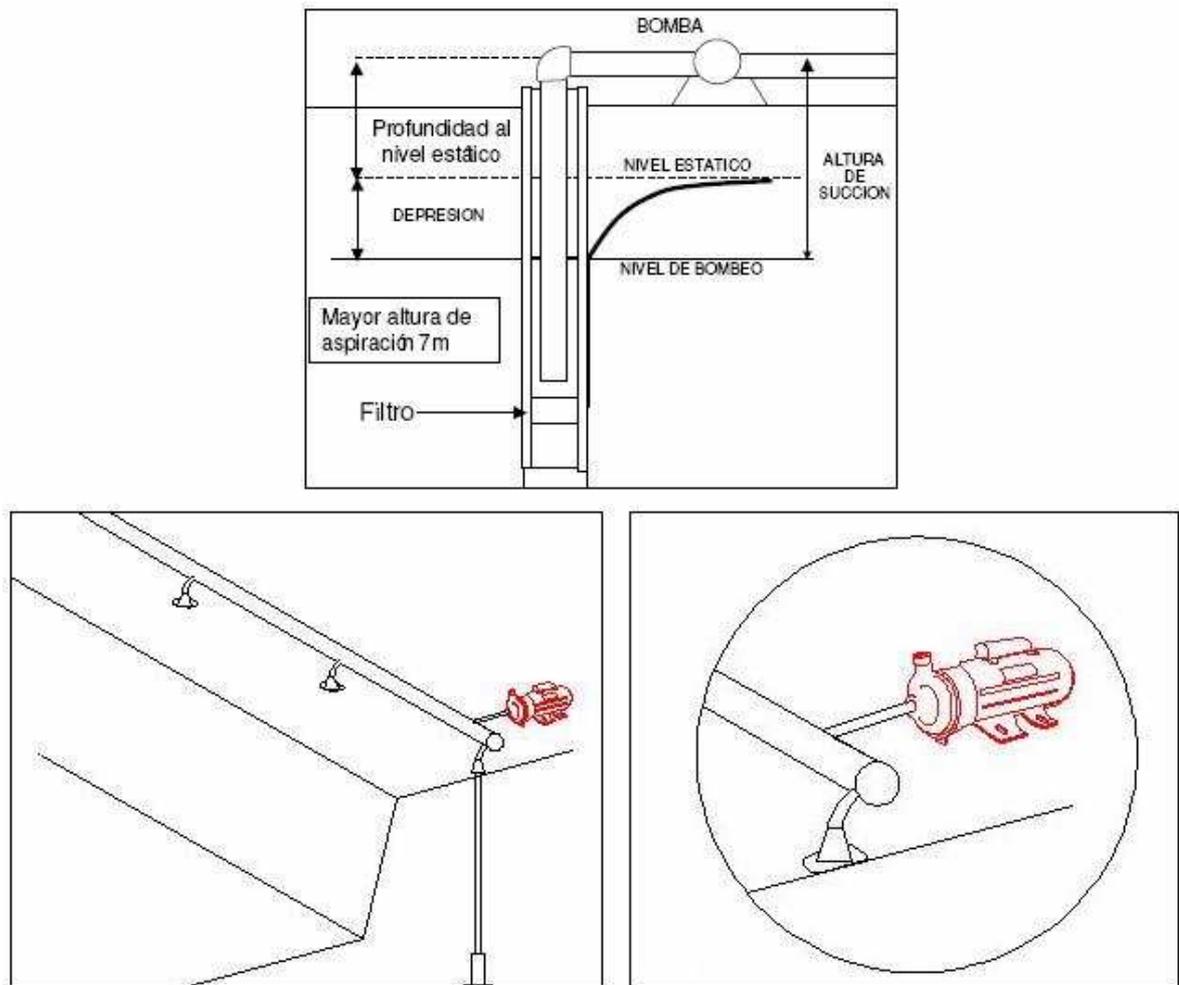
Sistema wellpoint: (a) Corte esquemático del sistema de bombeo. (b) Viste en perspectiva de la distribución de la tubería. (c) Detalle de la bomba centrífuga y su conexión con el colector principal.
